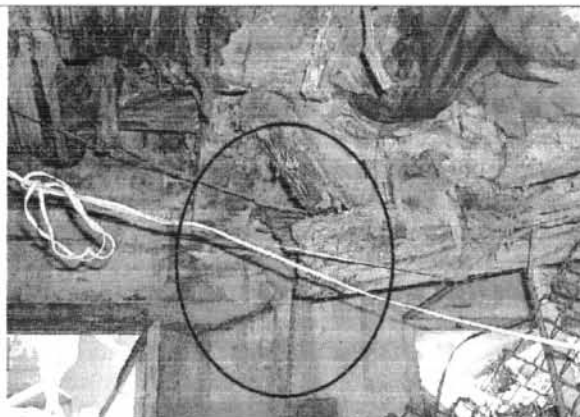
Los elementos de cubierta se encuentran sueltos con posibilidades de caída.
